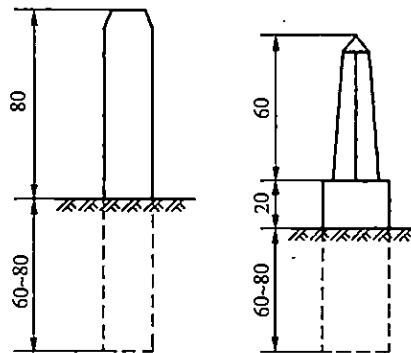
钢筋混凝土柱式护栏（单位：cm）
